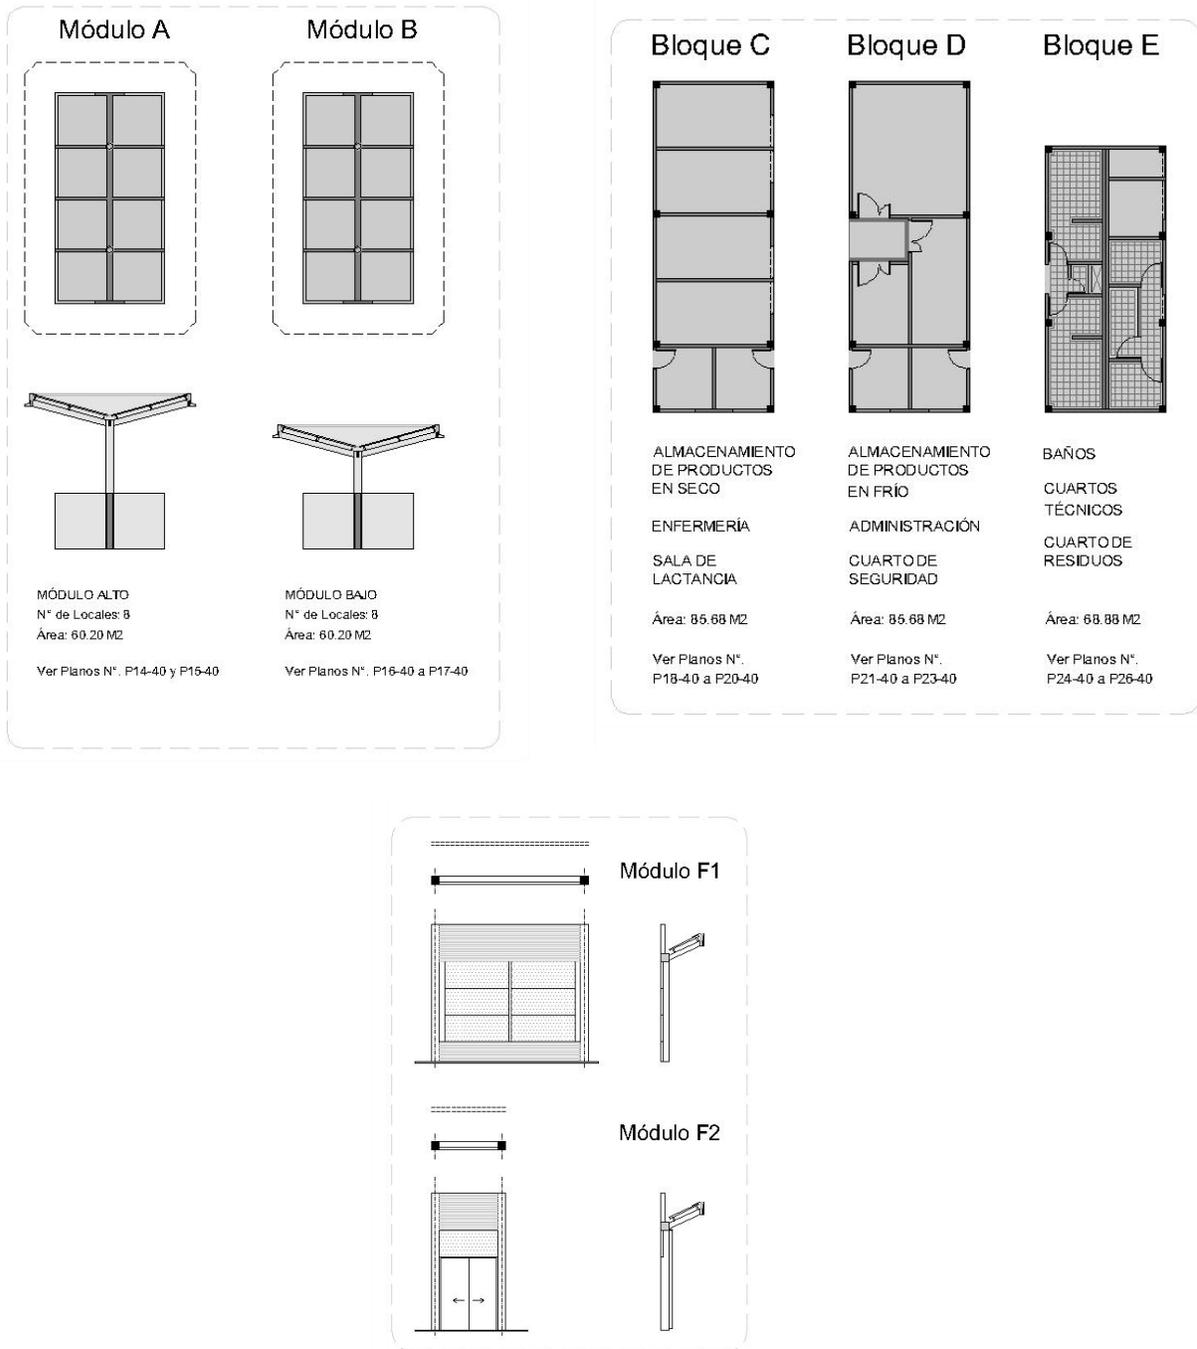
Módulos de locales, servicios y cerramiento. Fuente: Consorcio INGEOMAR.
